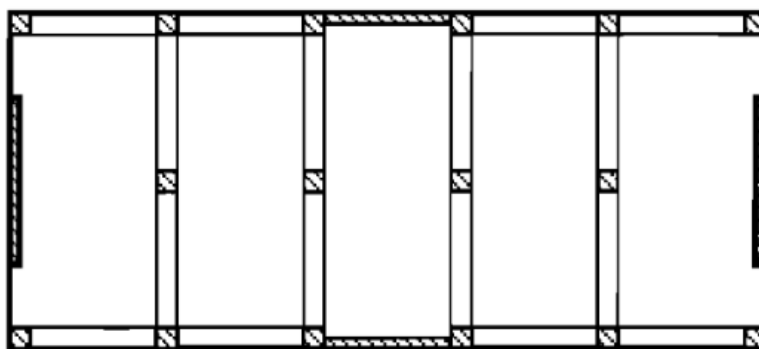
Vista en planta; Fuente: (Priestley, Calvi, & Kowalsky, 2007)
